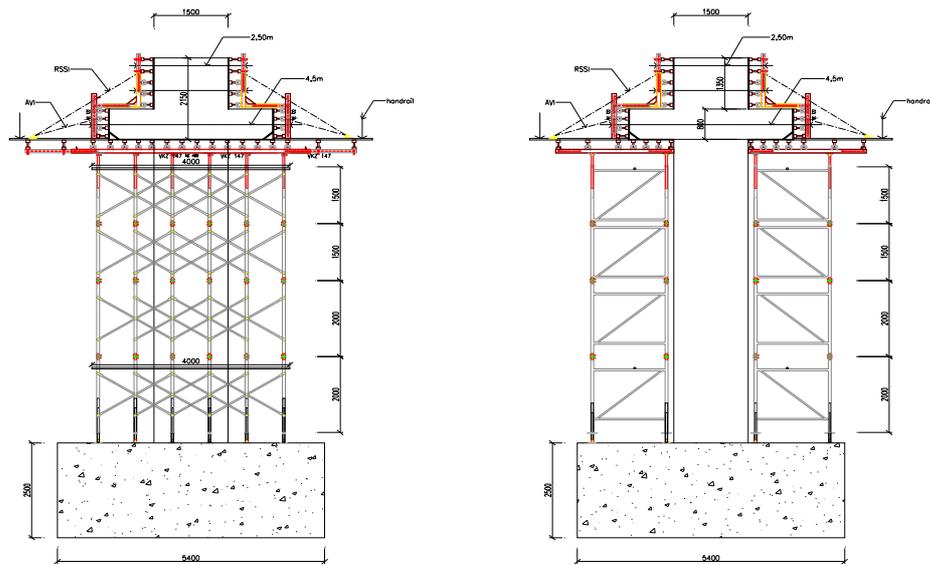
Tampak Atas Formwork Pier Tahap-2
